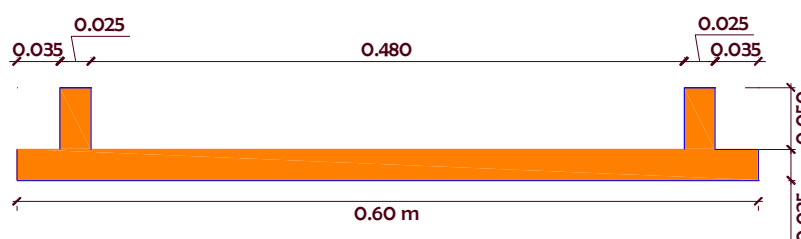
Detalle de sección transversal, largo: 0.60 m ancho: 0.075 m, espesor: 0.025 m, altura exterior: 2.80 m y altura interior: 2.10 m.
